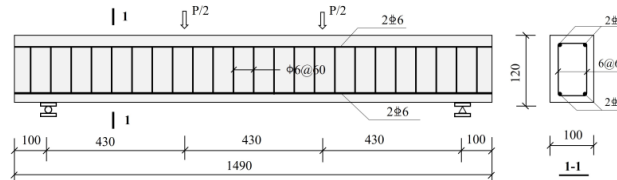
Layout de carga e geometria da viga de BA (unidade mm).
